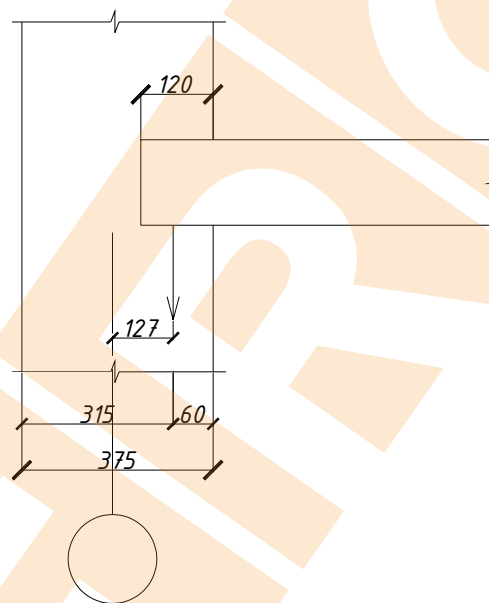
Схема навантаження простінку від міжповерхового перекрыття
